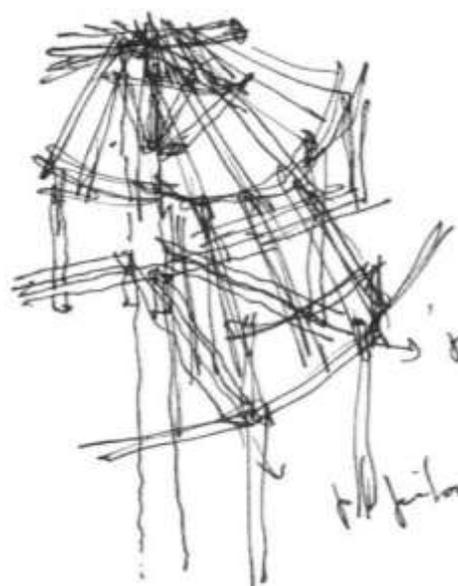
Vista demonstrando a miríade de pilares e vigas a alturas distintas. Foto: CANTALICE II.
